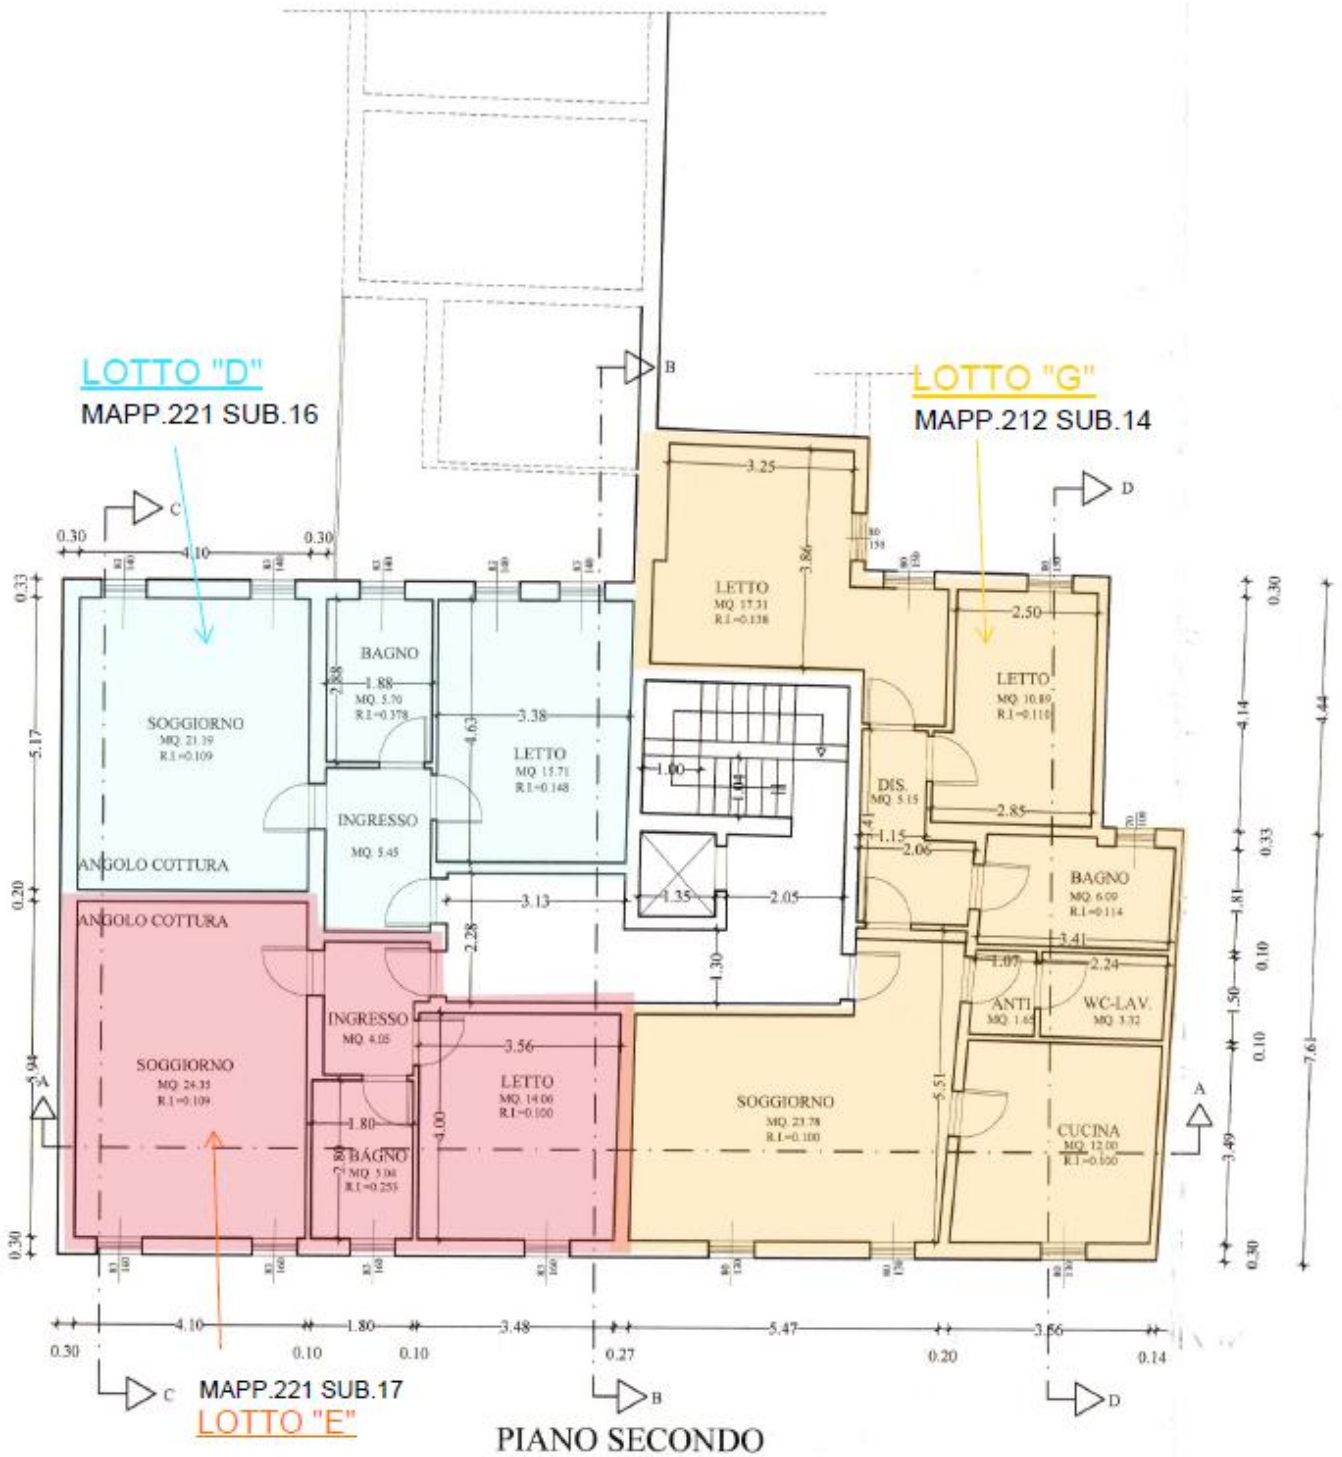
Stralcio D.I.A. 33/2007 Tav. n. 4 - Piano Secondo - Fuori Scala
